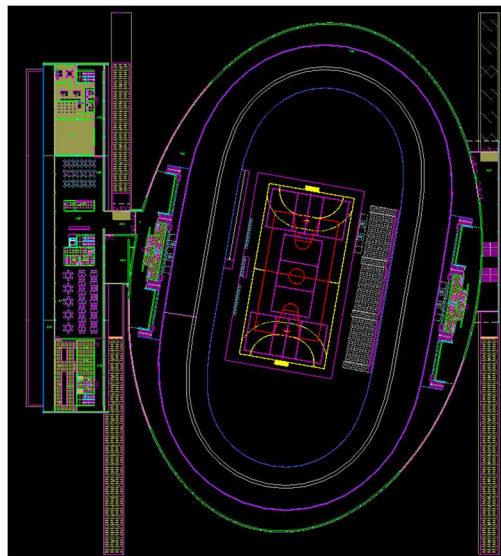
Exemplo da Planta do piso 1 (formato "DWG")
